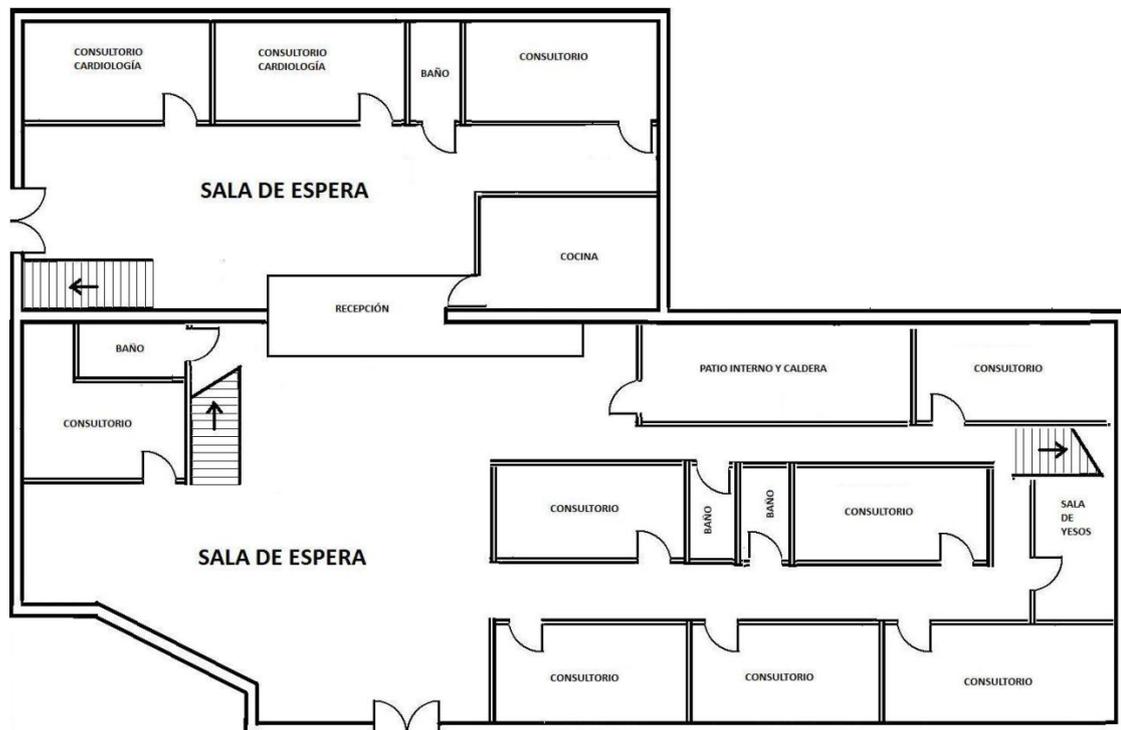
LAY OUT PROPUESTO, PLANTA BAJA.
